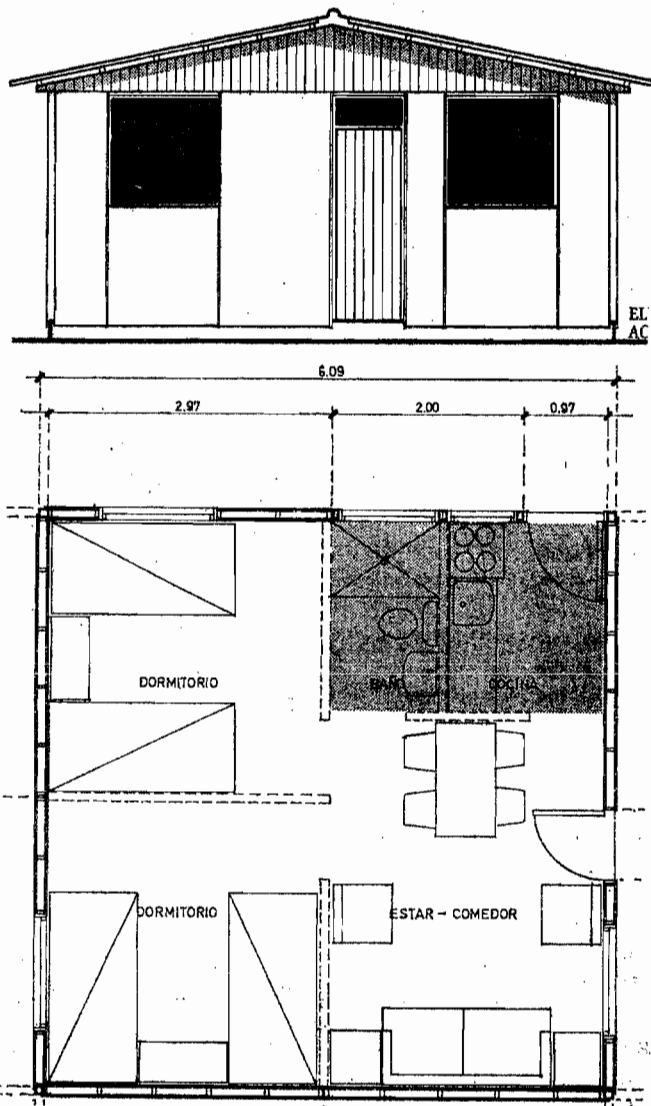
Planta elevación de un tipo de vivienda de asbesto-cemento del Programa 20.000/70.
